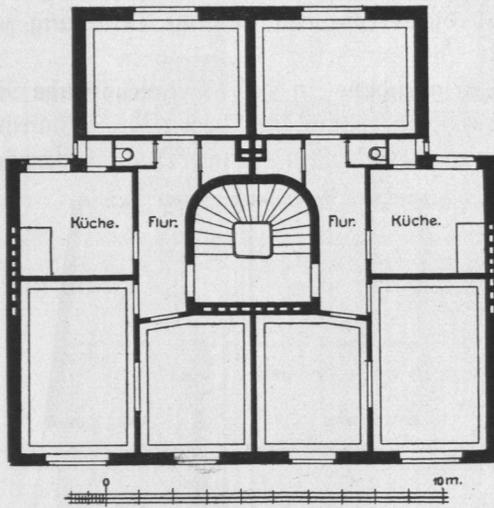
Haus Nieburstraße Nr. 20, Obergeschoß.
